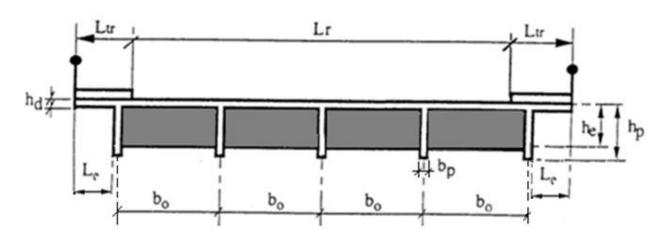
Profil schématique sur appui d'un tablier à poutres en BA.
